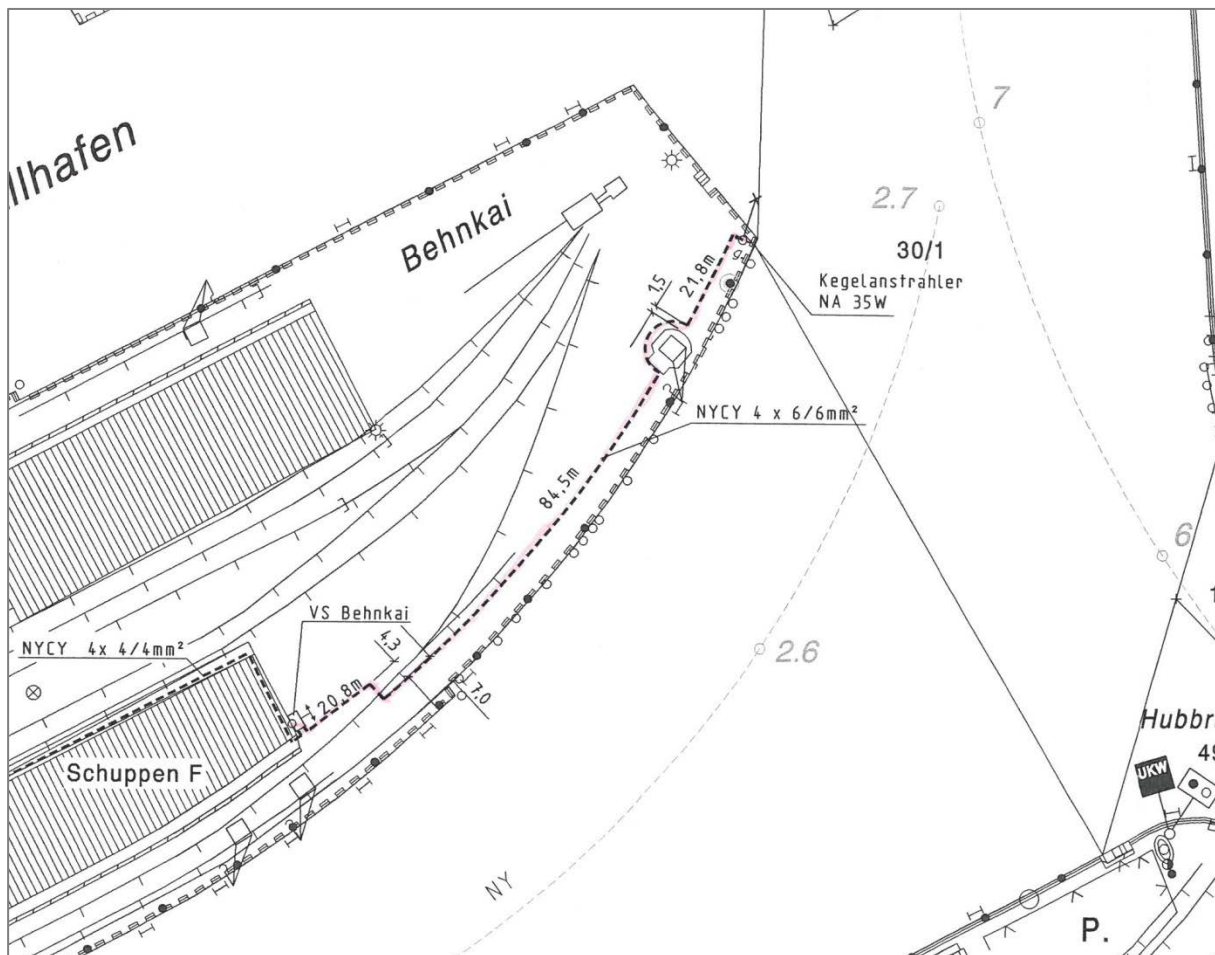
Kabellageplan Kegelstrahler (Quelle: WSA)
